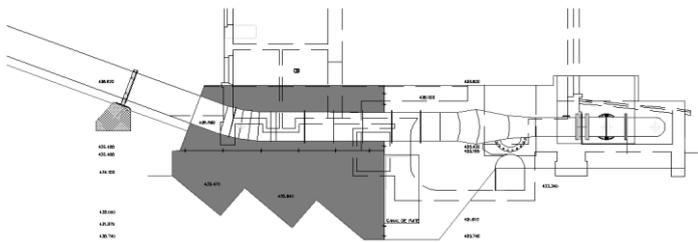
Nouveau massif d'appui PF7, plan en coupe
